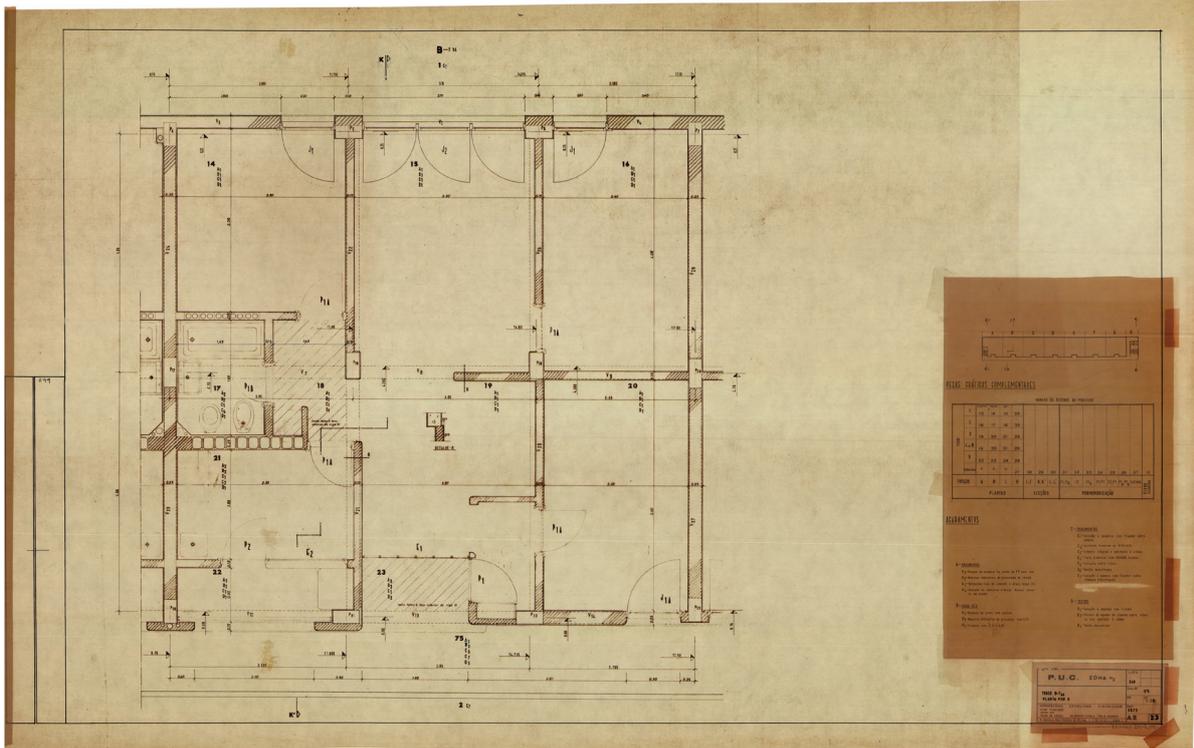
Projeto: lote 249, troço B – T3A, planta piso 9
